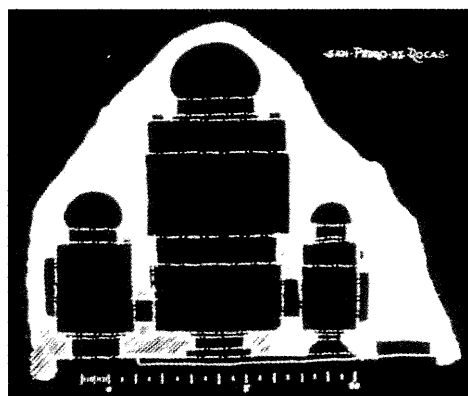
Planta de San Pedro de Rocas (Orreaga)
